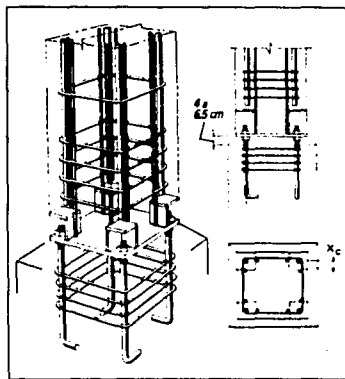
PLACAS DE BASE DE COLUMNA IGUALES O MENORES QUE LA SECCION TRANSVERSAL DE LA COLUMNA.
